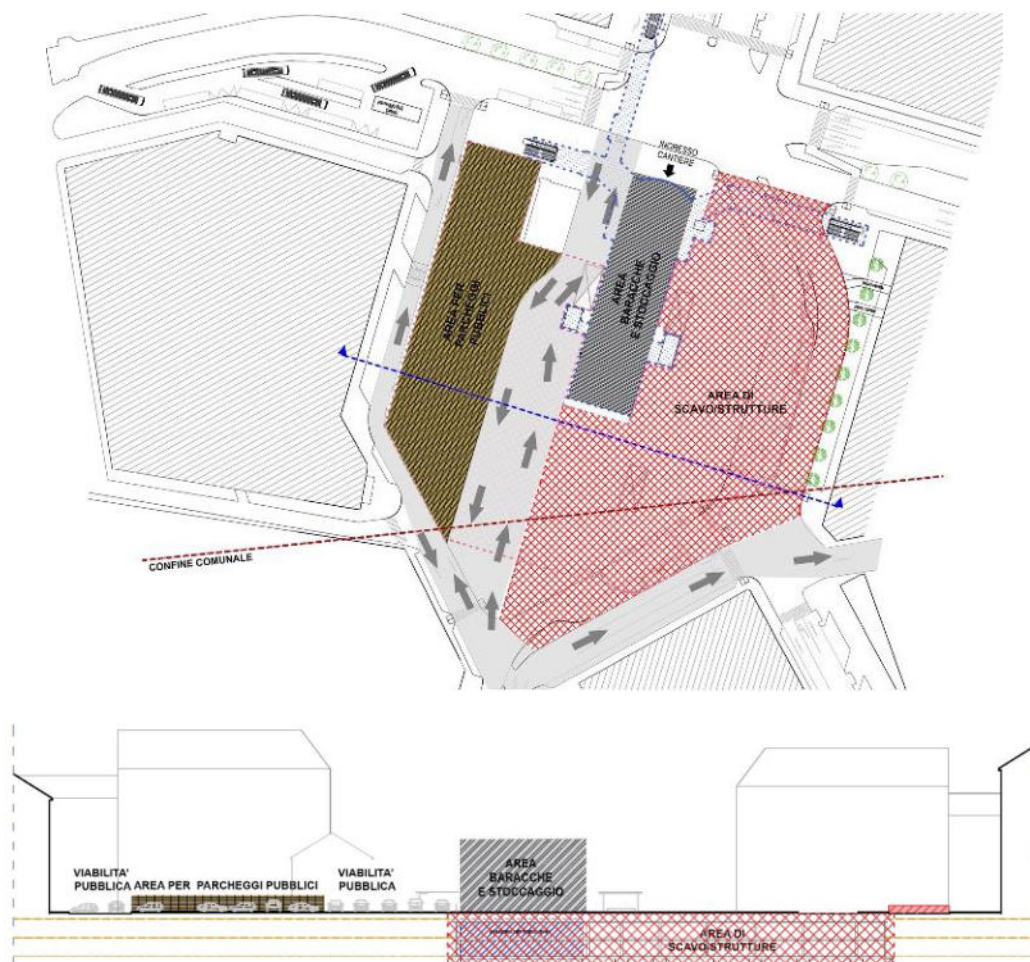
Pianta e sezione dell'organizzazione di layout per la Fase 1
